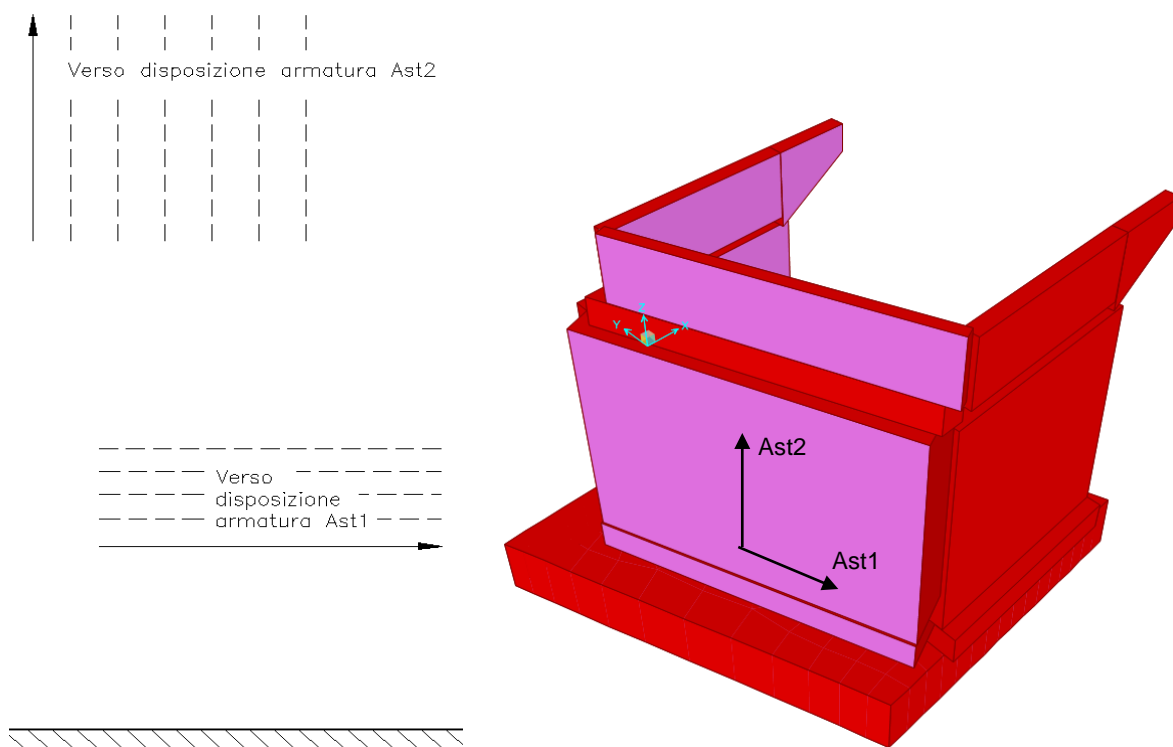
Richiesta di armatura elevazione: convenzioni
